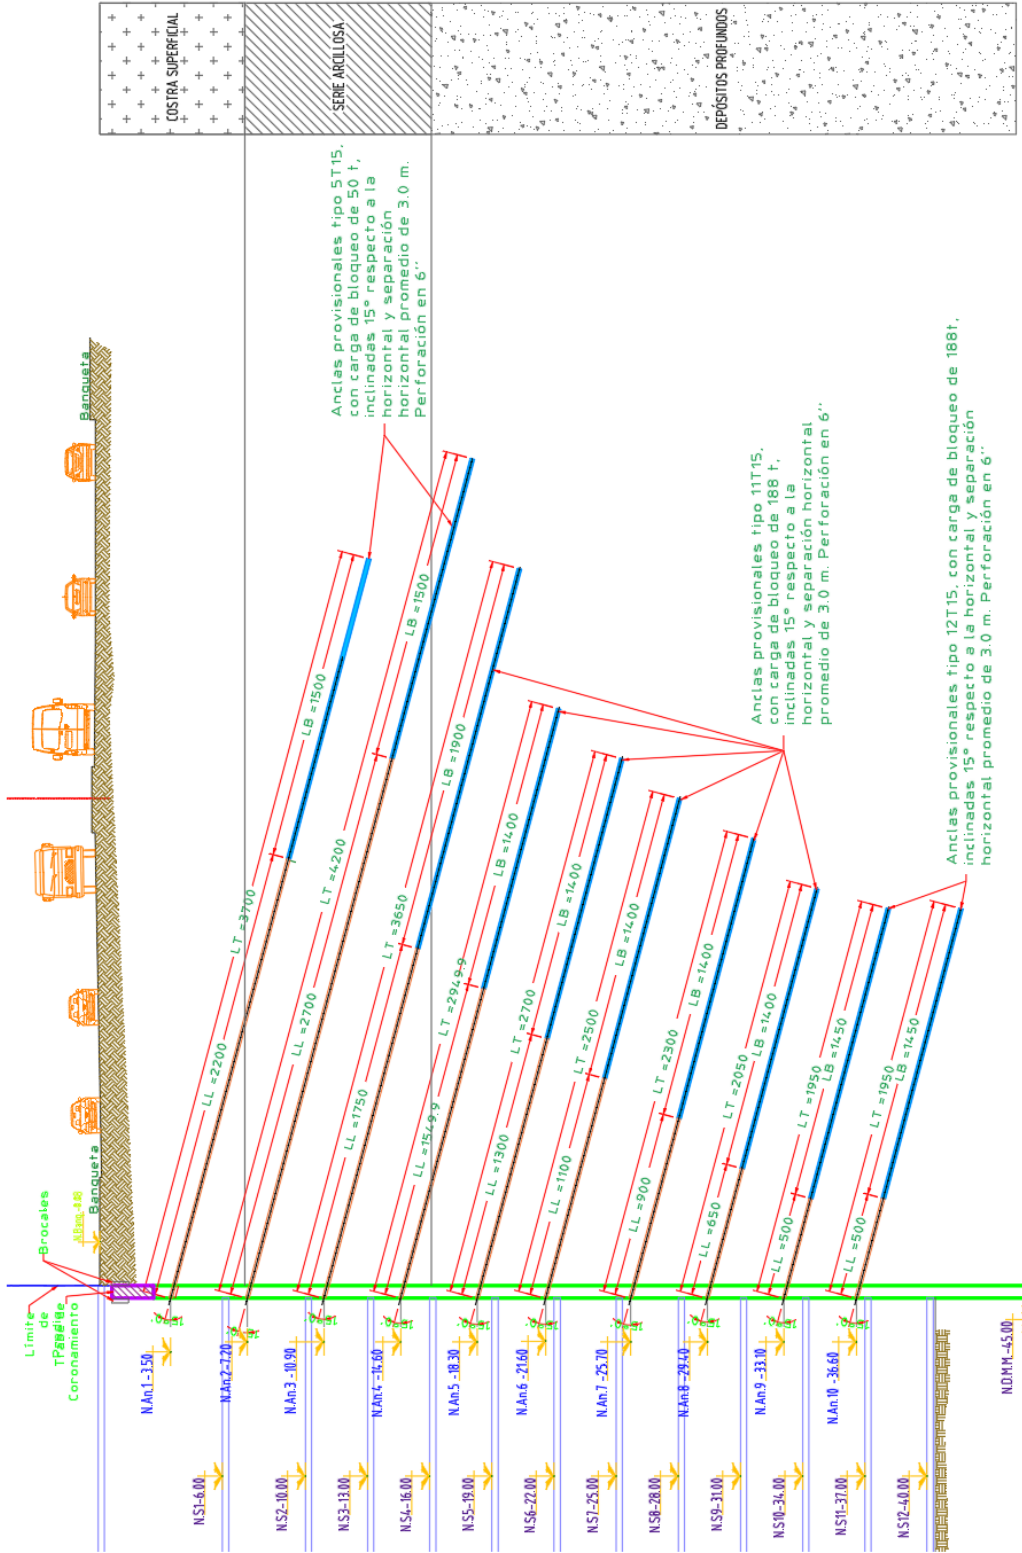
Sistema de estabilización. Corte en las demás de colindancias
